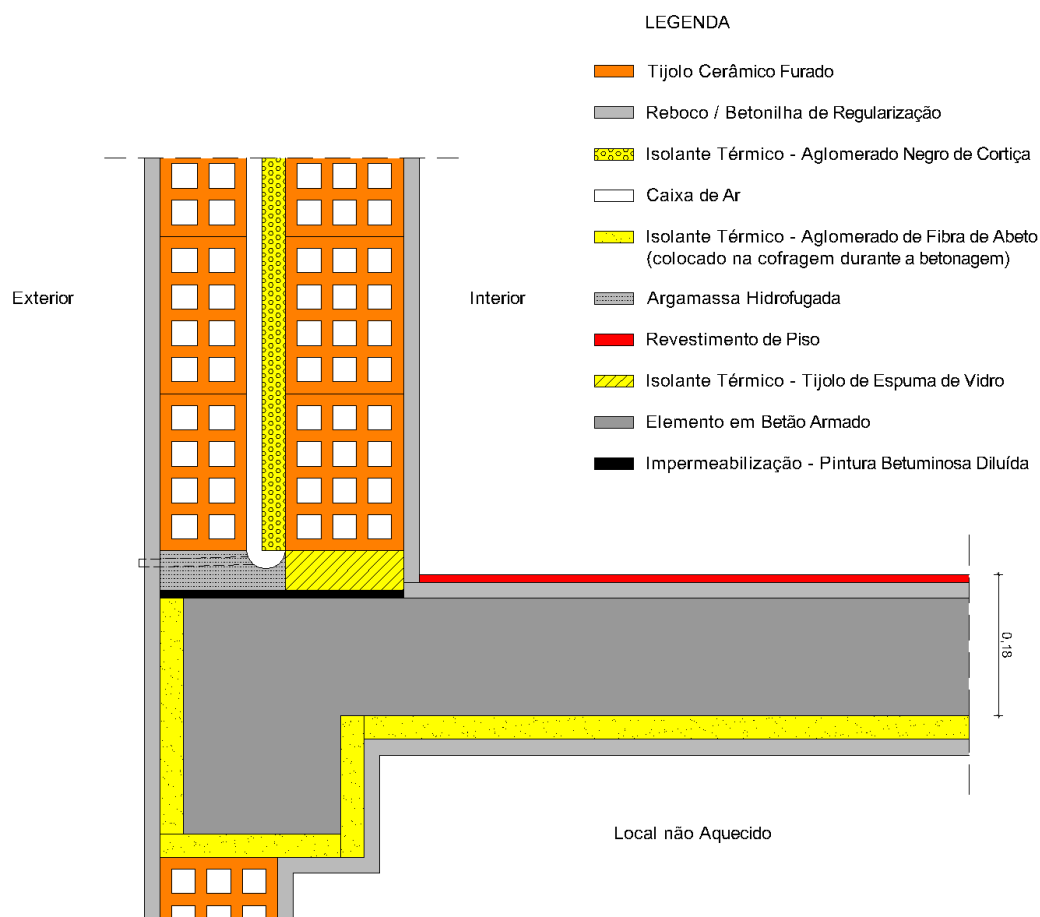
Ligação da fachada com pavimento sobre local não aquecido, adaptado de [10]
